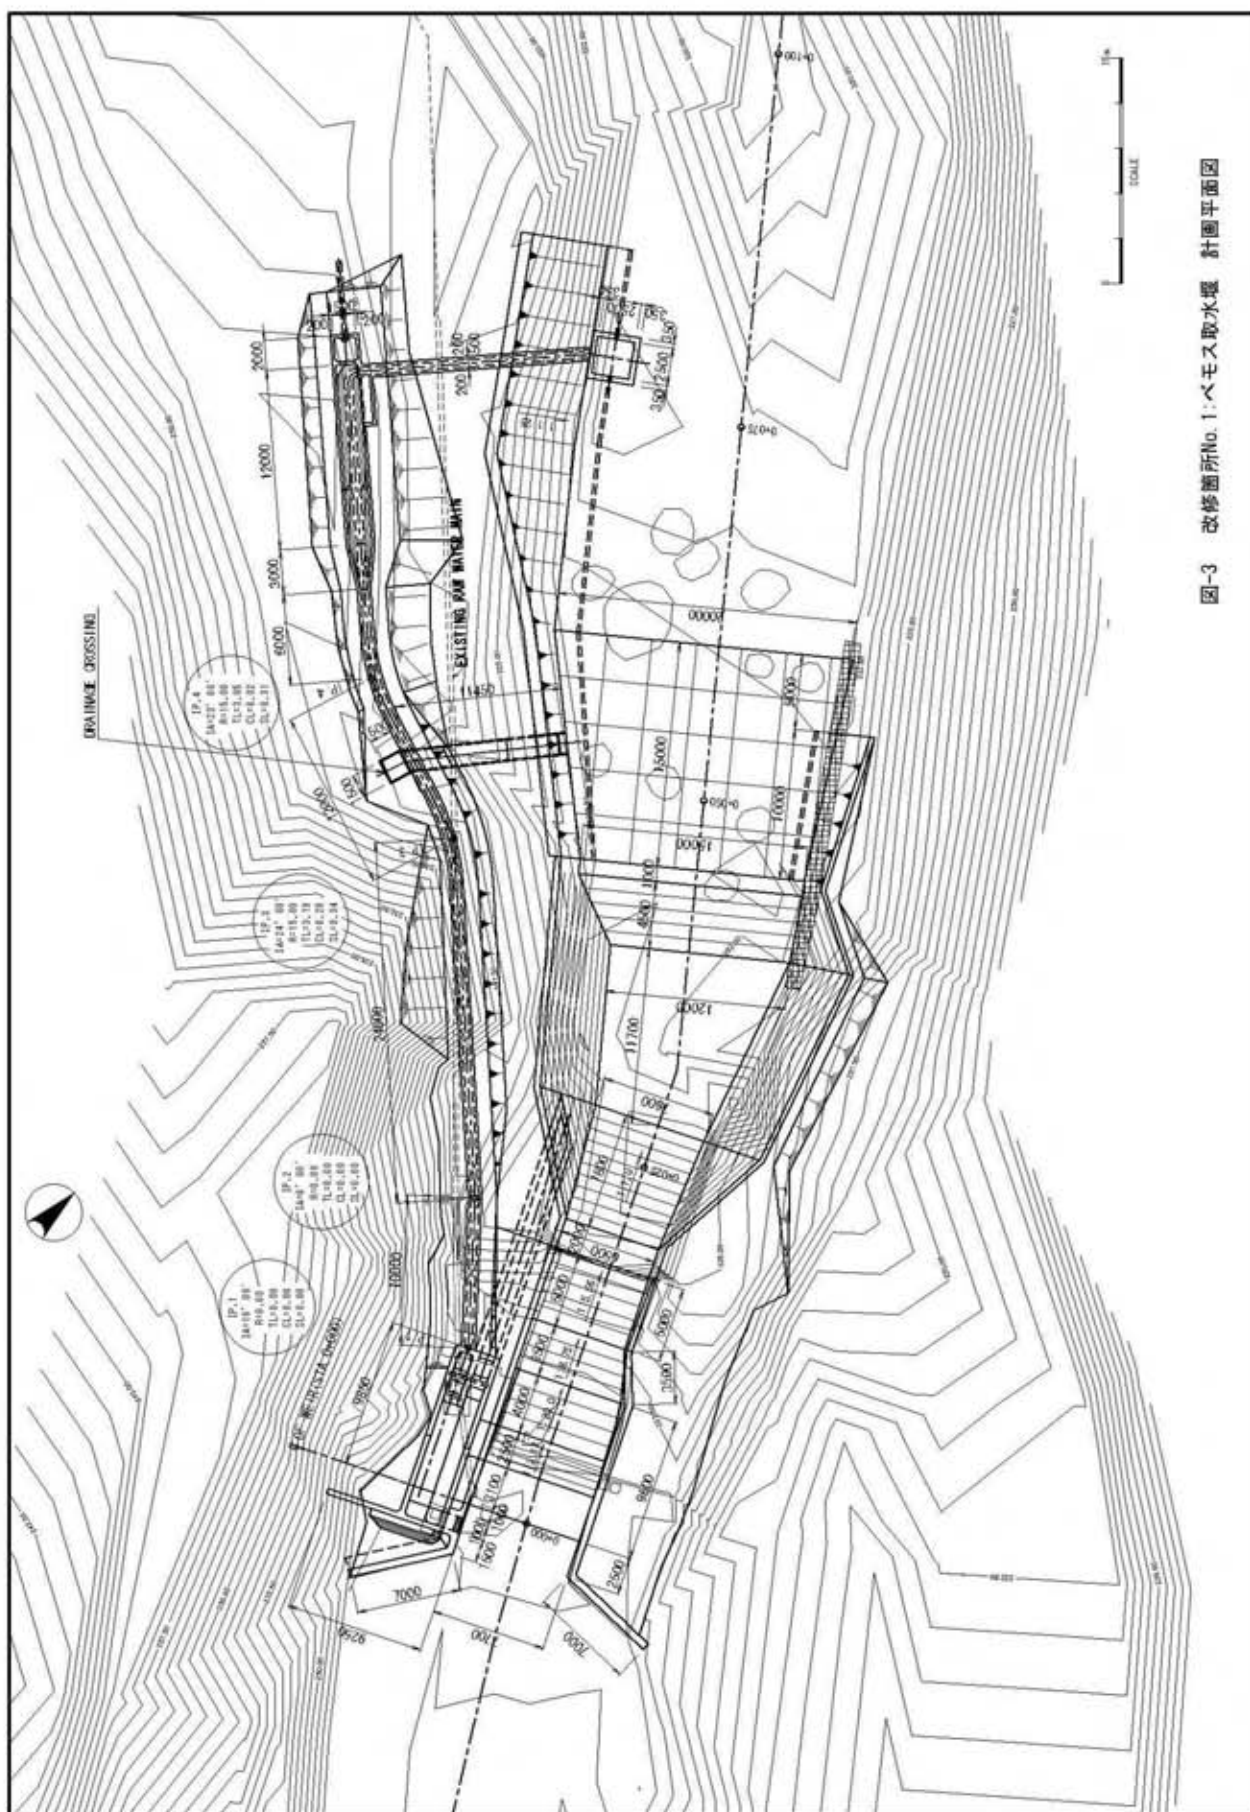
改修箇所No.1:ベモス取水堰 計画平面図
